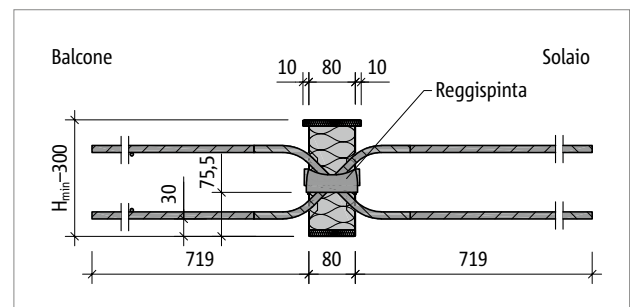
Schöck Isokorb® T tipo QL-VV5 – QL-VV6: sezione del prodotto
